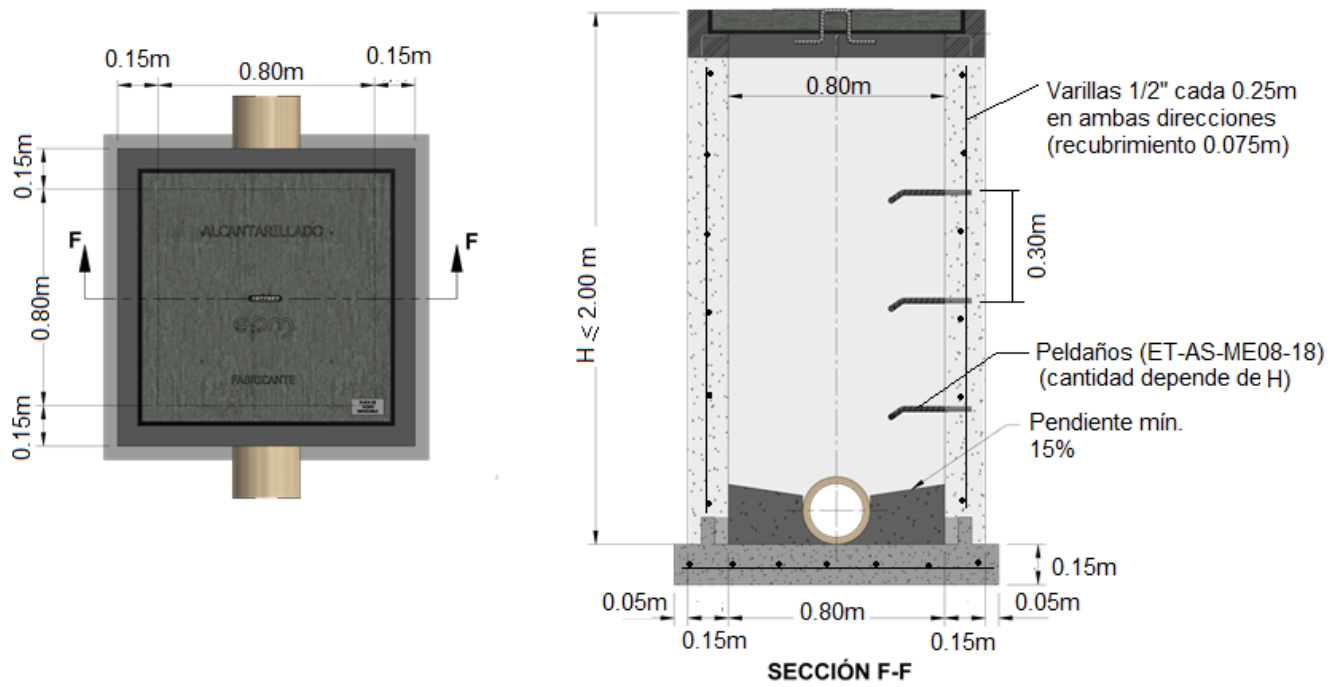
Caja de inspección tipo 2 – Planta y sección transversal
